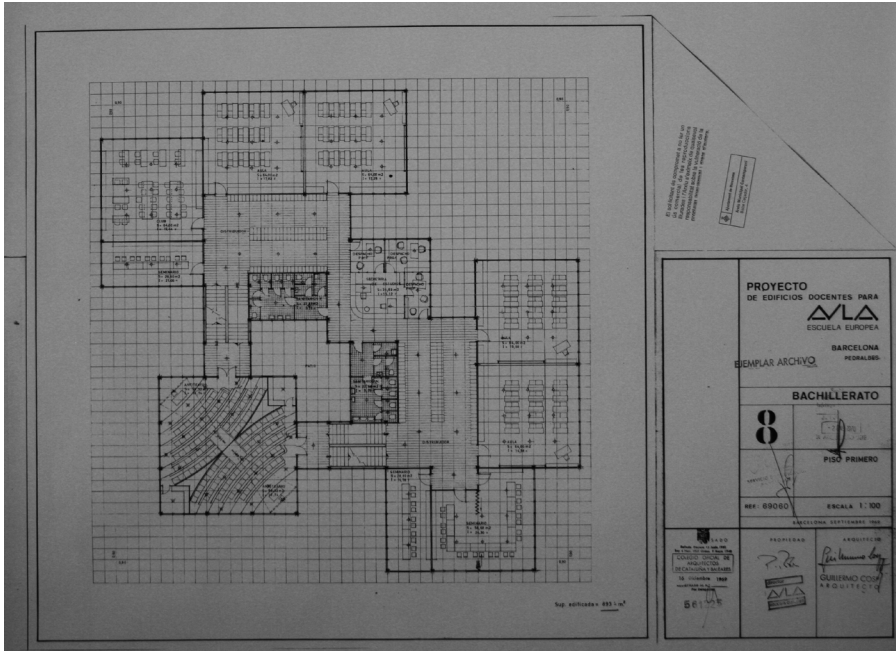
Edificio de bachillerato, planta baja, proyecto septiembre 1969. F: AMCB
